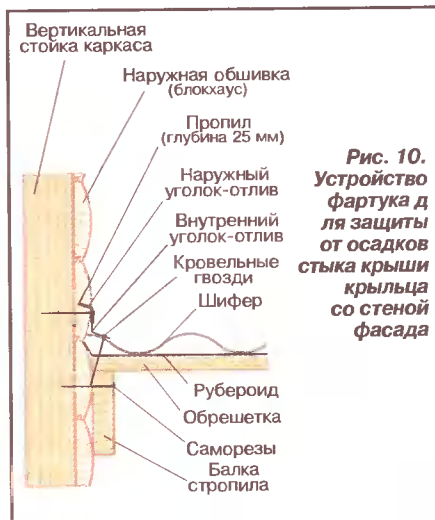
Устройство фартука для защиты от осадков стыка крыши крыльца со стеной фасада
